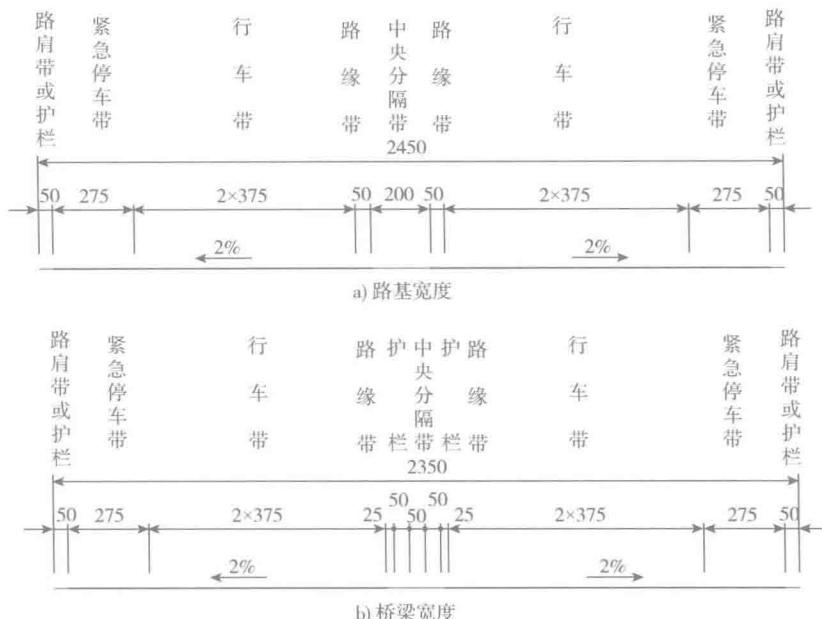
道路和桥梁宽度(尺寸单位:cm)
